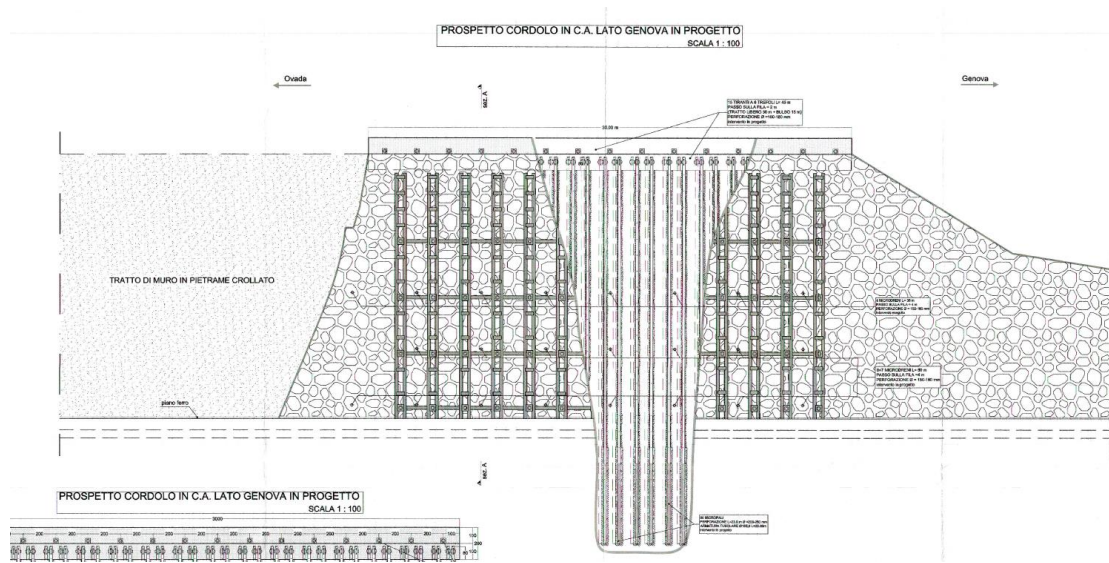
Stralcio degli interventi realizzati di consolidamento del muro in muratura lato Genova.
